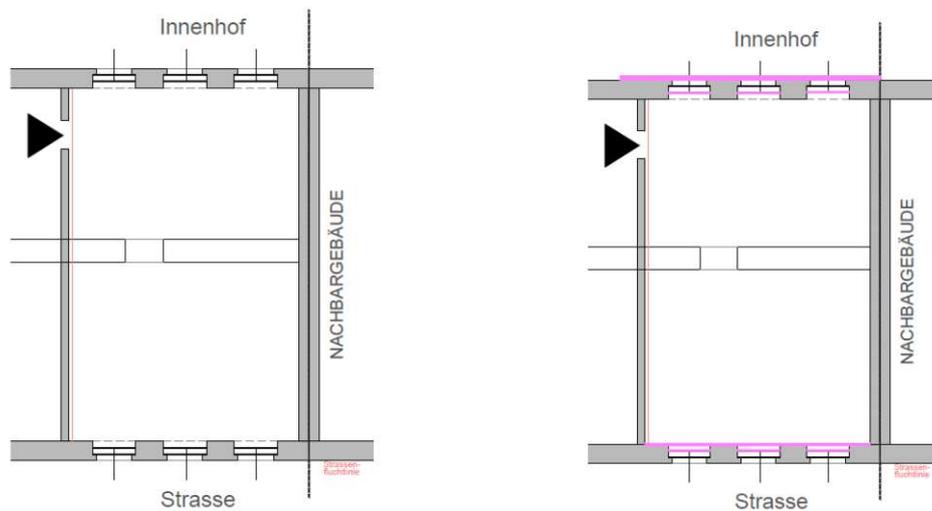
Systemgrundriss Erdgeschoss: Bestand – Saniert (eigene Darstellung)
